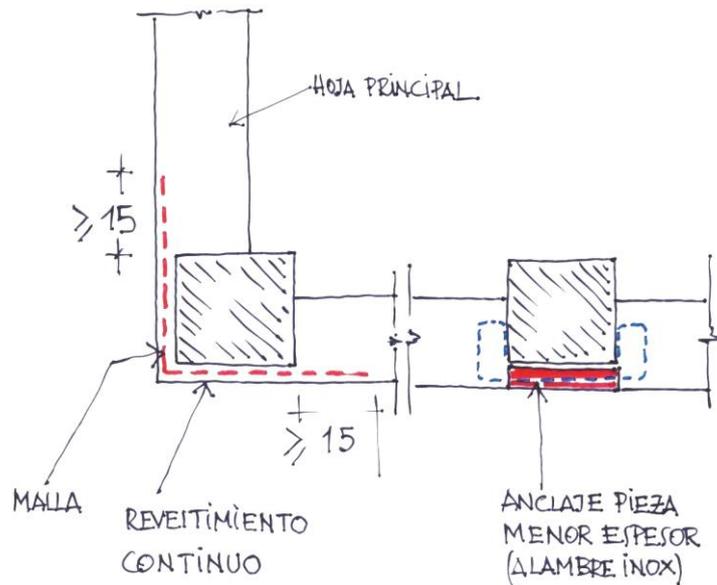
Esquema de encuentro hoja principal – pilares (hoja principal interrumpida en pilares)
